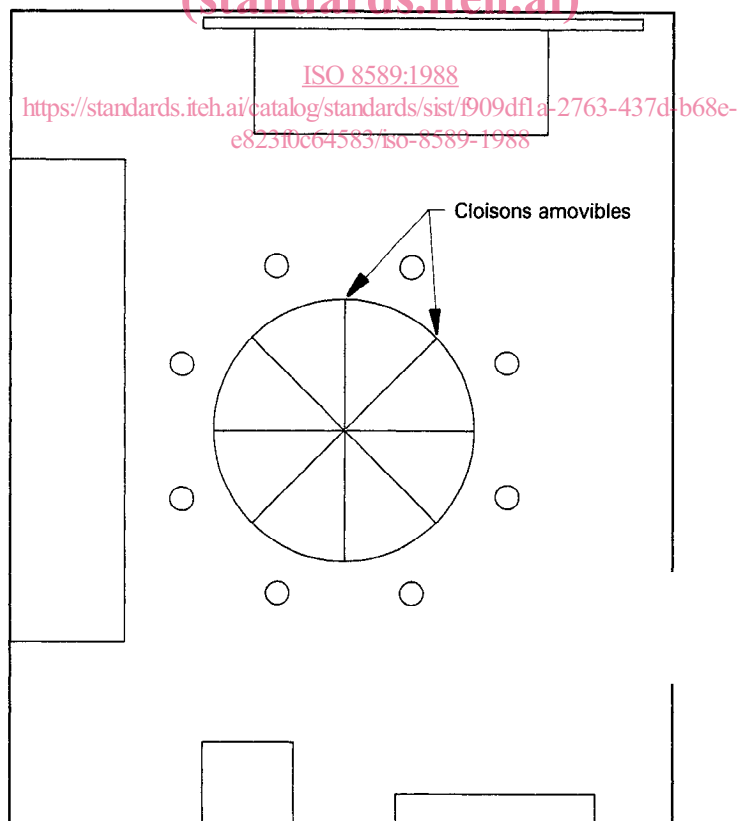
Exemple de plan de local d'essai servant à la fois pour le travail en cabines ou en groupe
